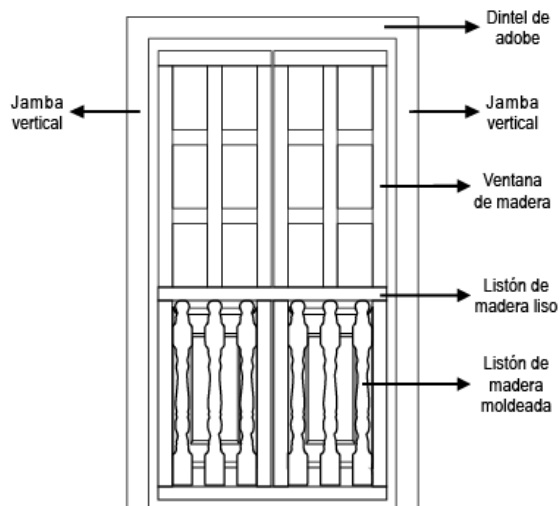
En la ilustración se observa la ventana de la planta alta tipo balcón original de la vivienda con un diseño ecléctico.
